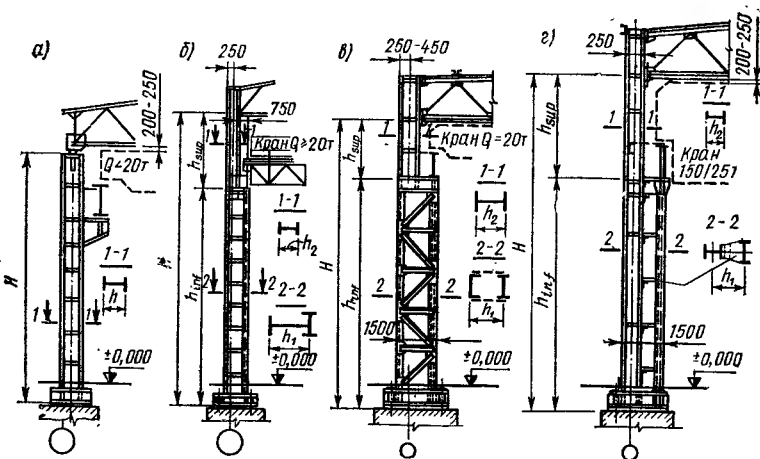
Основные типы внецентренно сжатых колонн промышленных зданий
